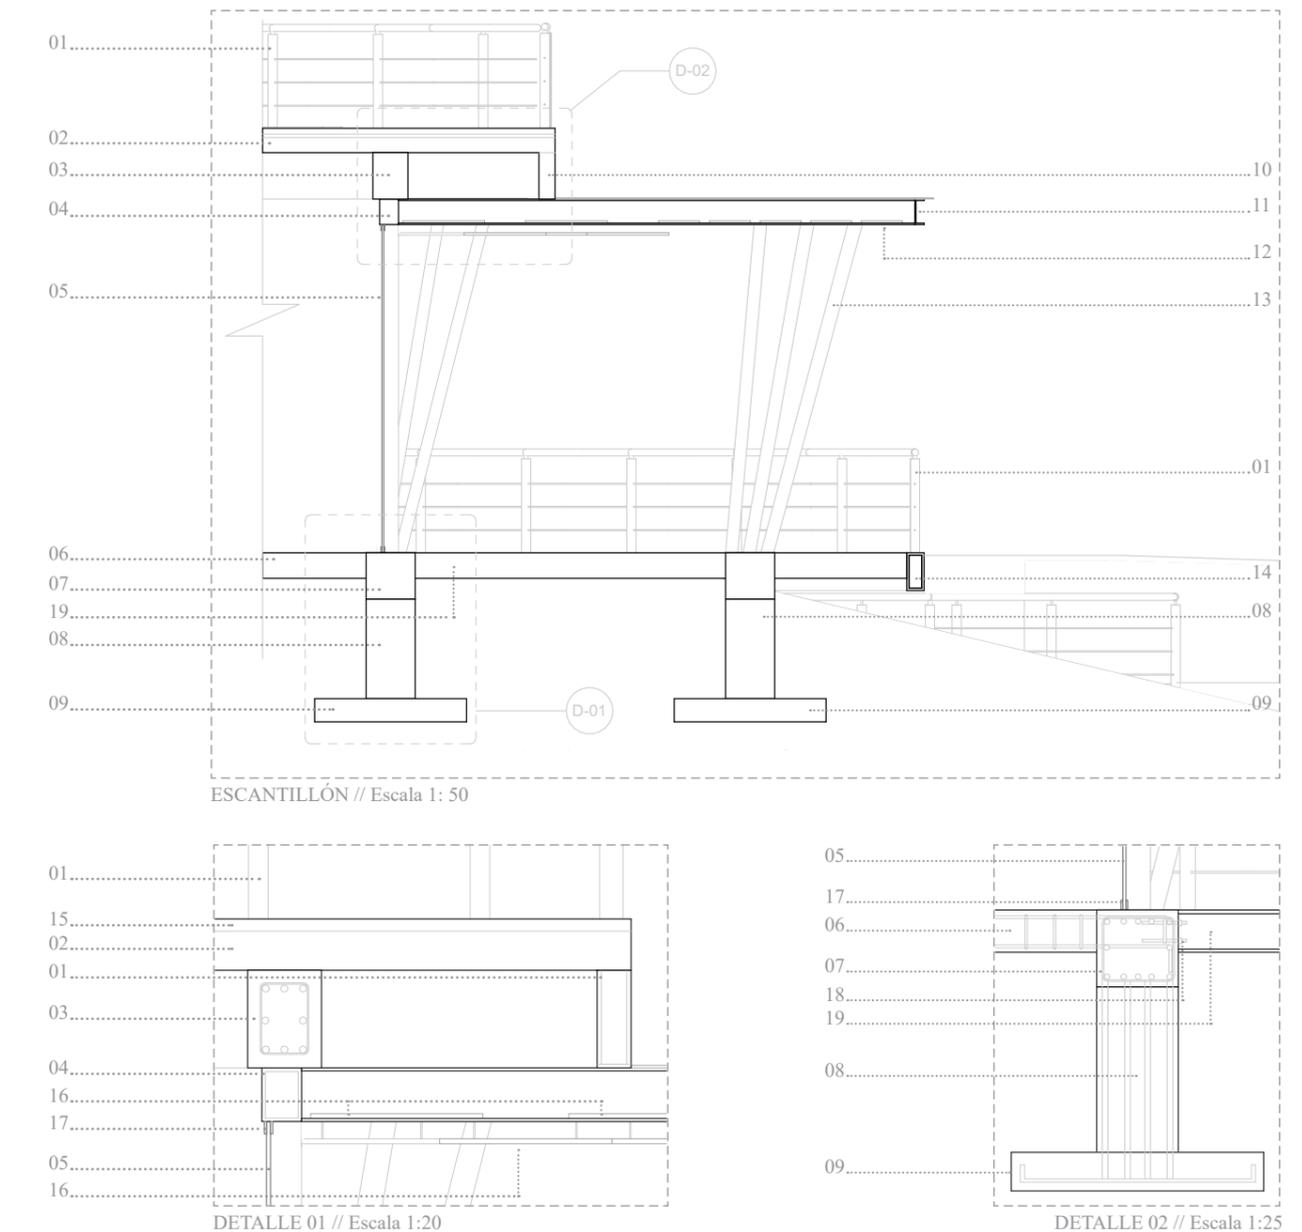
Detalles arquitectónicos y constructivos de equipamiento (Autor, 2021)
